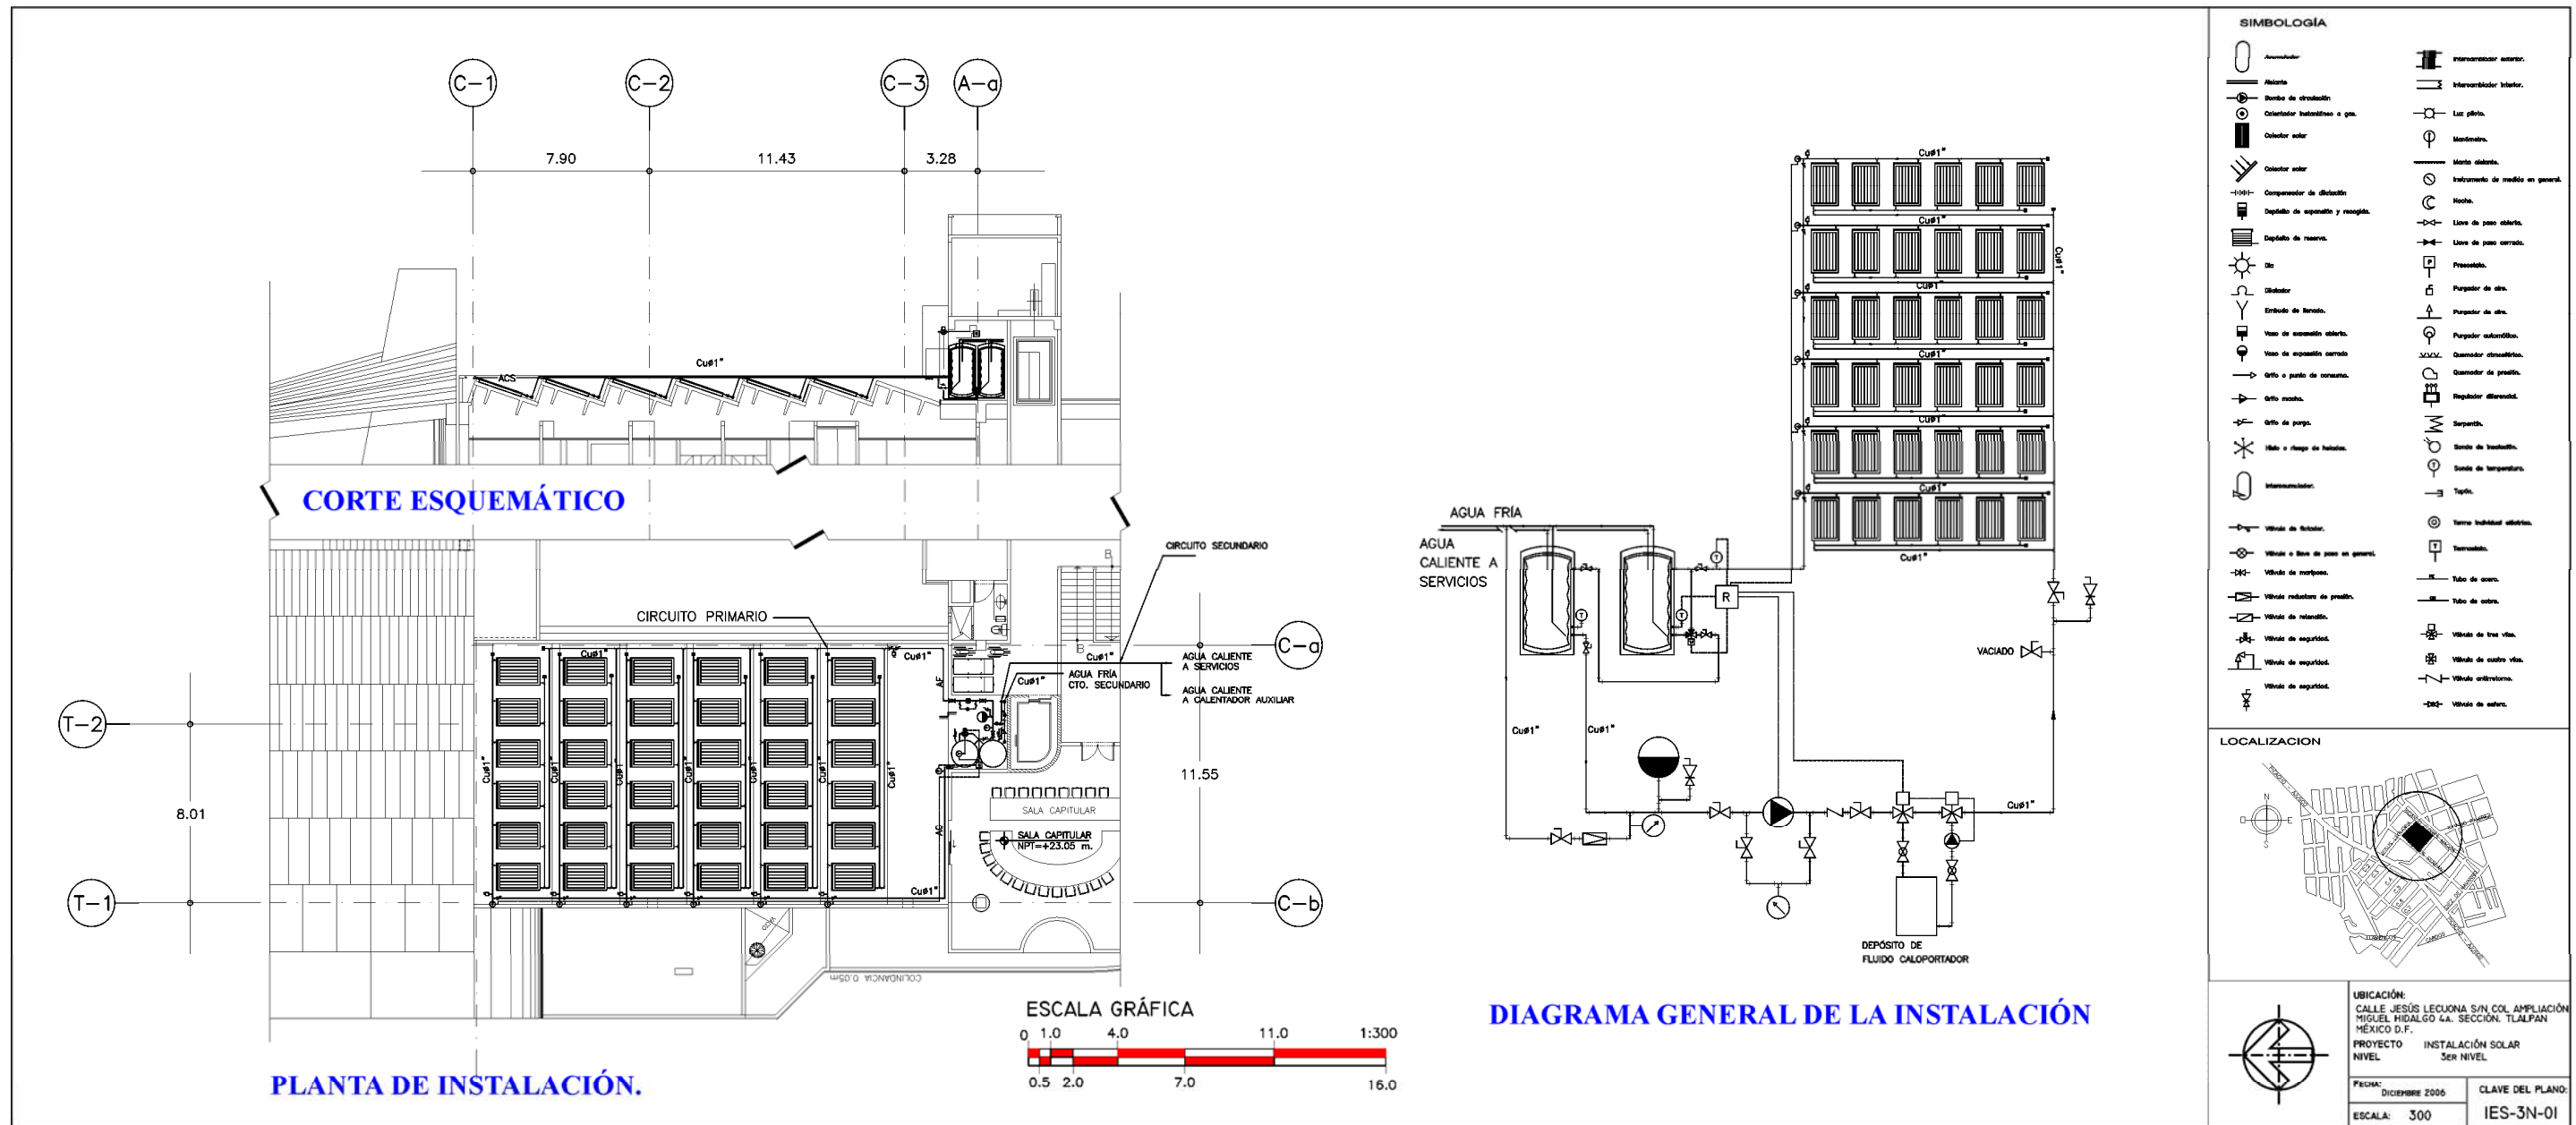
El proyecto solar. Plano de instalación. CRZ
